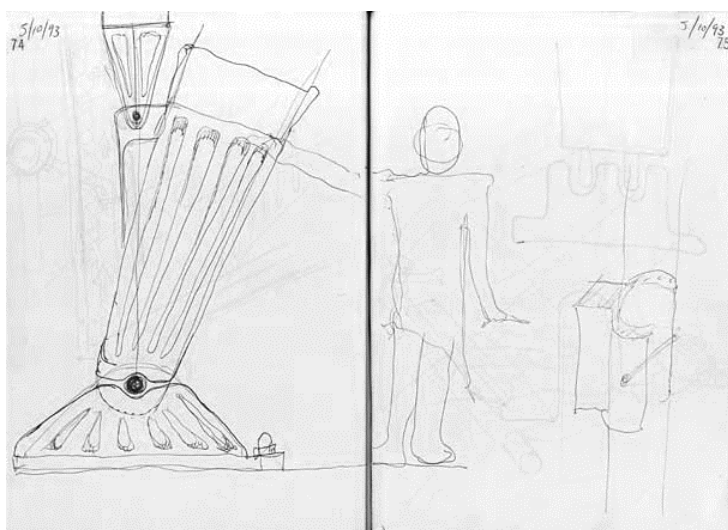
Desenho do arquiteto. Concepção dos apoios articulados.
